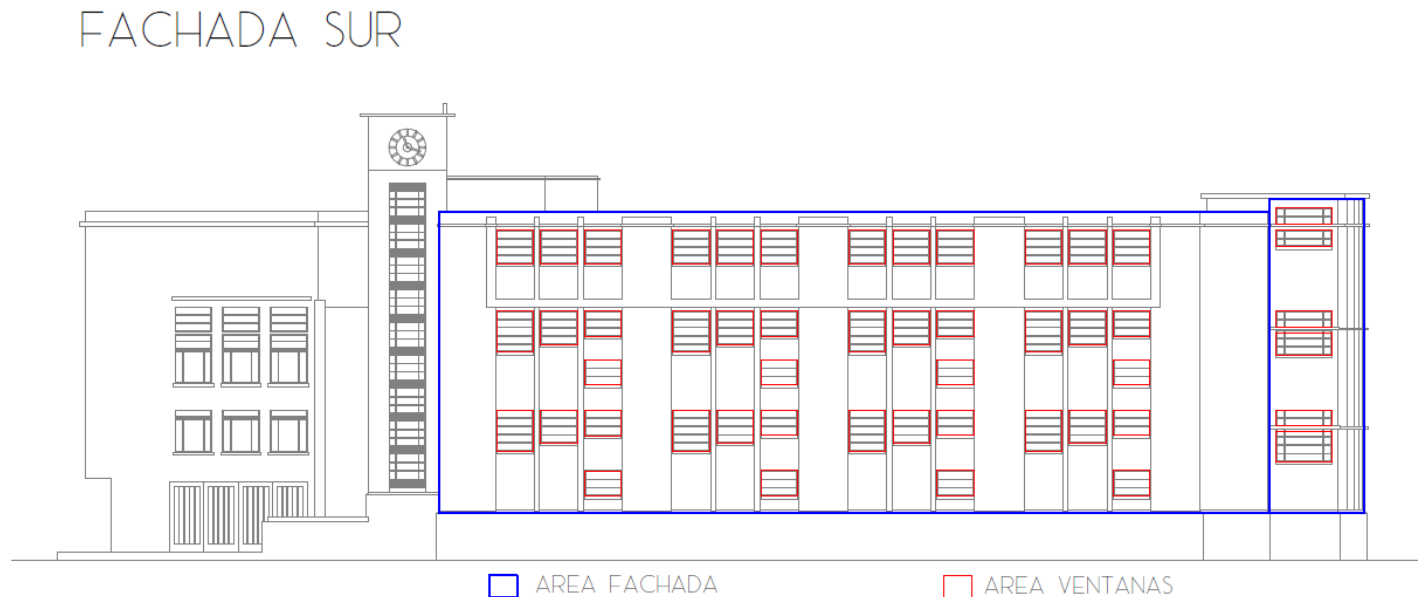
Área de vidrio en fachadas, Fuente: Creación propia
